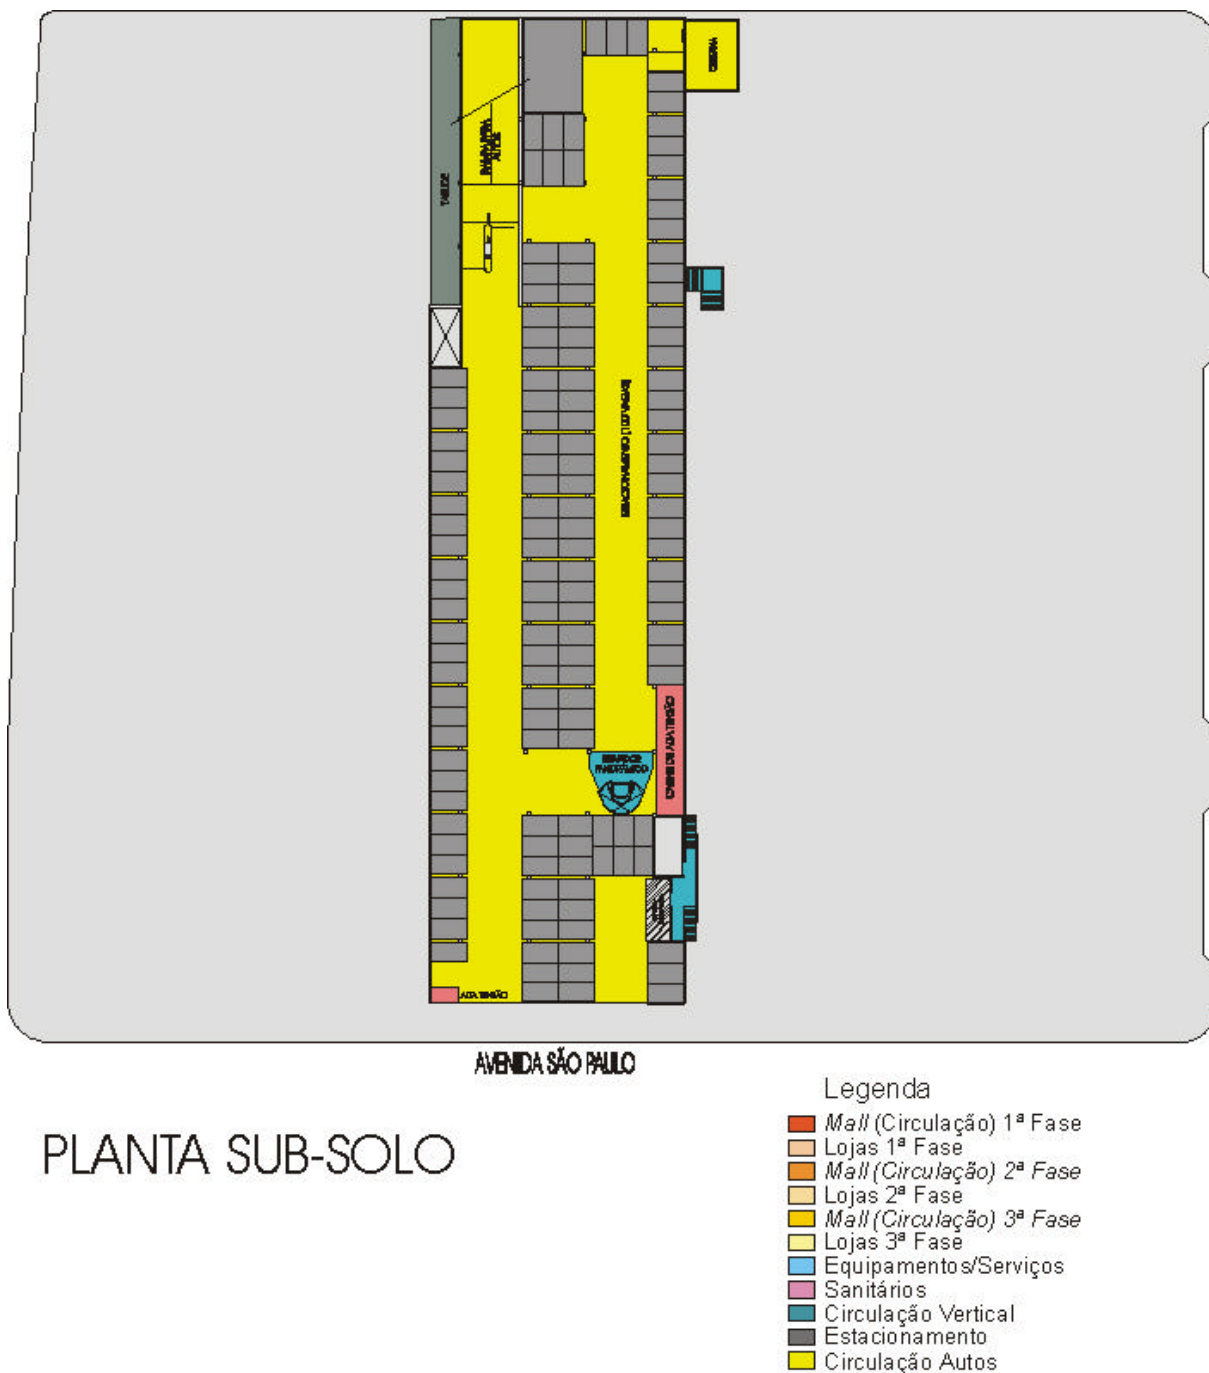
Planta do sub-solo - Shopping Avenida Center
